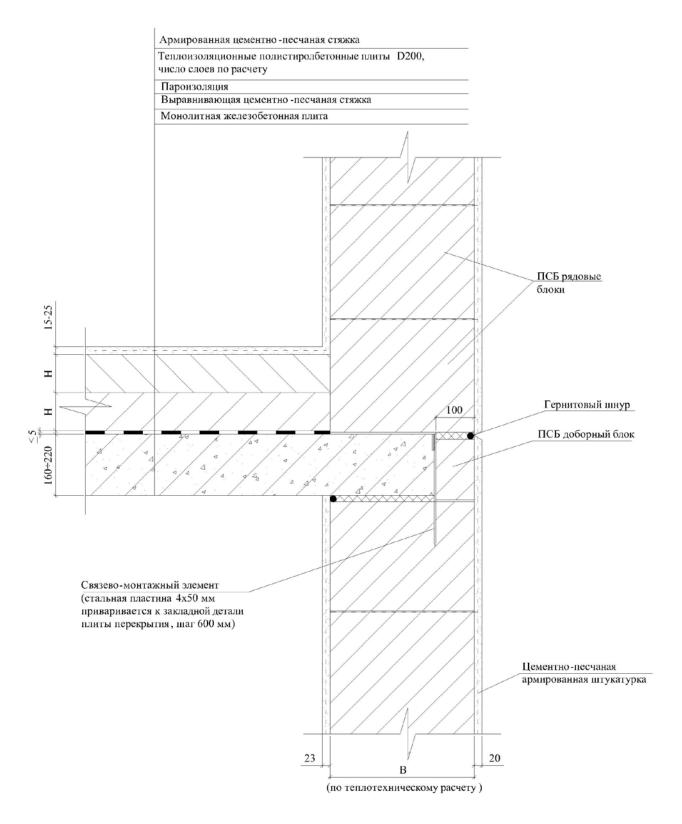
Утепление чердачного перекрытия с использованием теплоизоляционных плит из полистиролбетона
